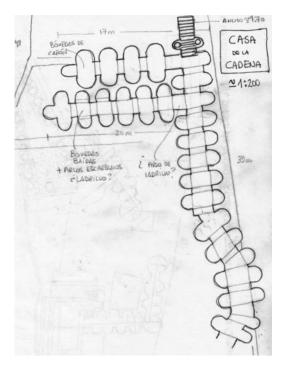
Esquema en planta de la cueva de la Casa de la Cadena
